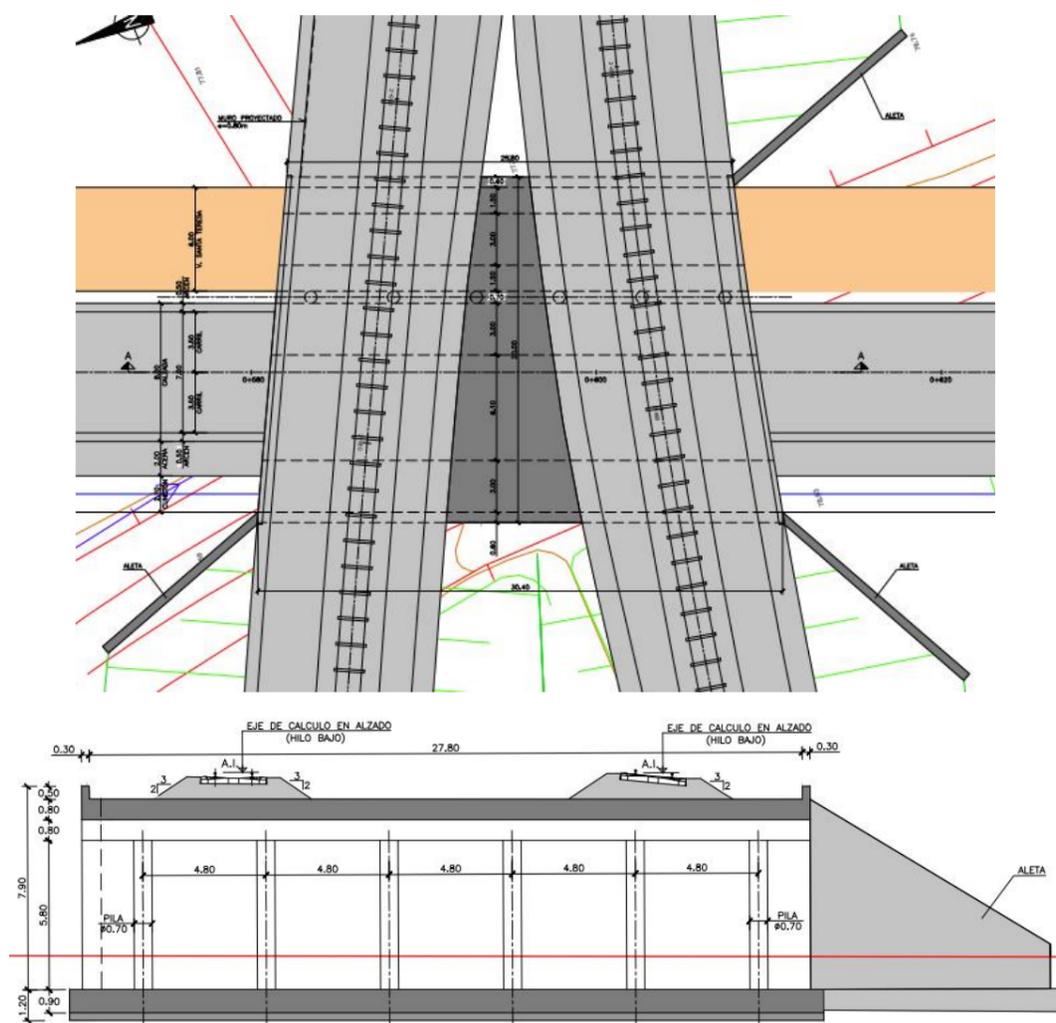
PLANTA Y ALZADO DEL PASO INFERIOR P.K. 2+990
